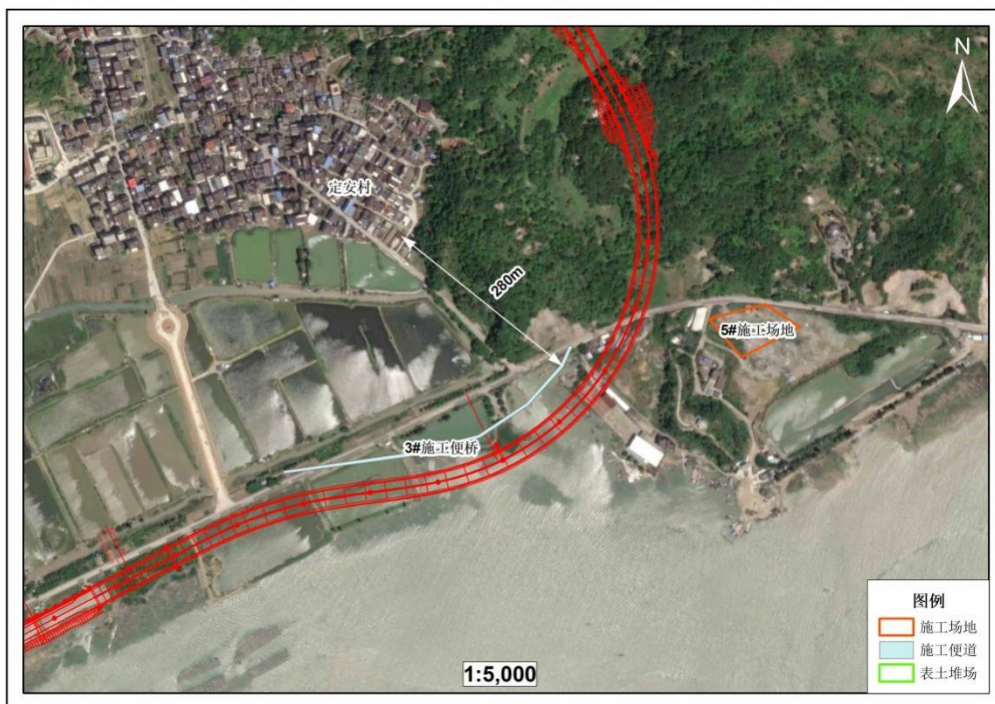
临时工程平面布置示意图（3#施工便桥、5#施工场地）
